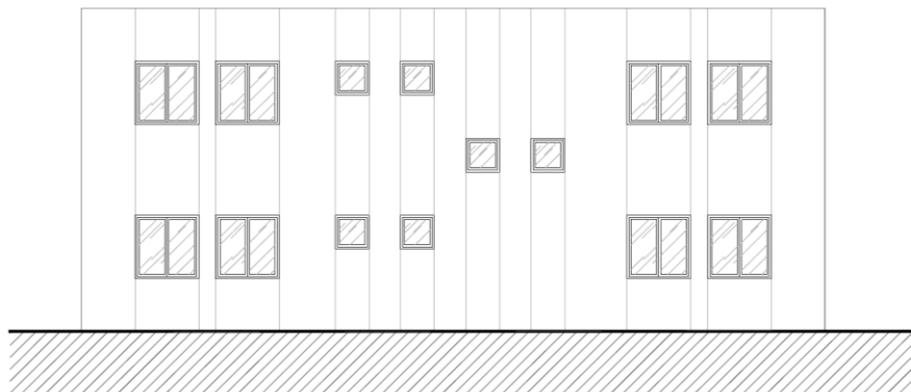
“Piccola palazzina per uffici. Prospetto Nord”
